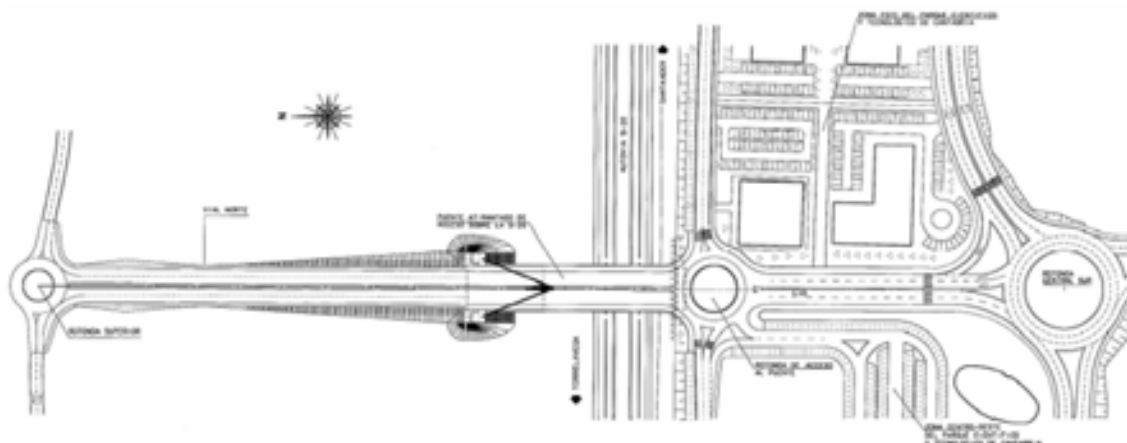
Planta del emplazamiento en el acceso al Parque Tecnológico
